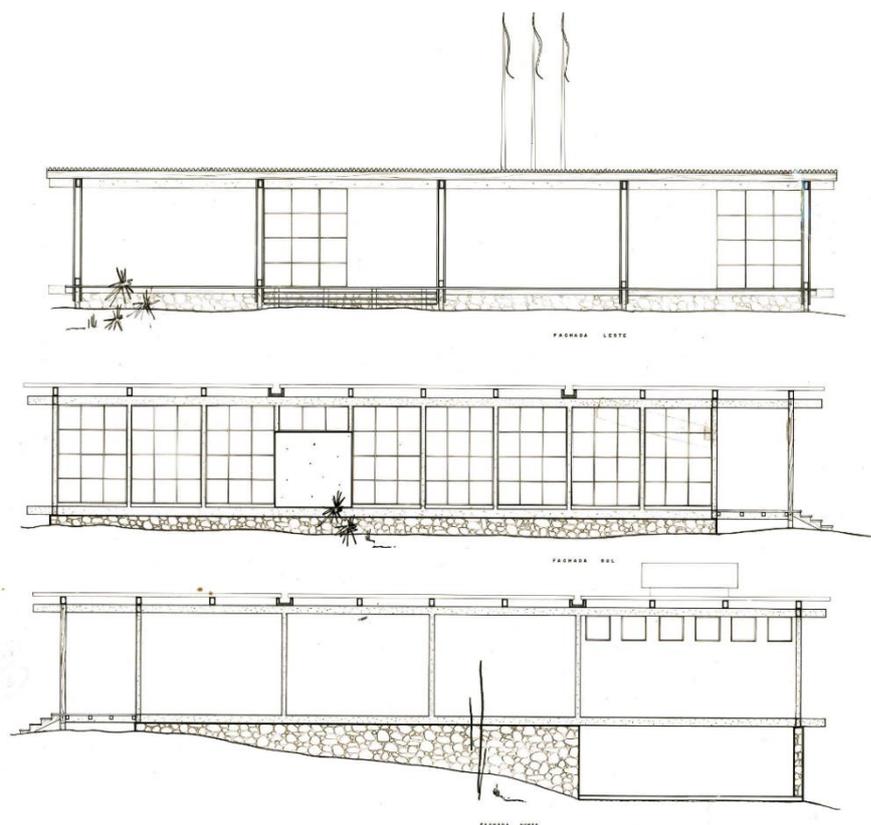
Fachada Leste (frontal), Fachada Sul e Fachada Norte do edifício.
